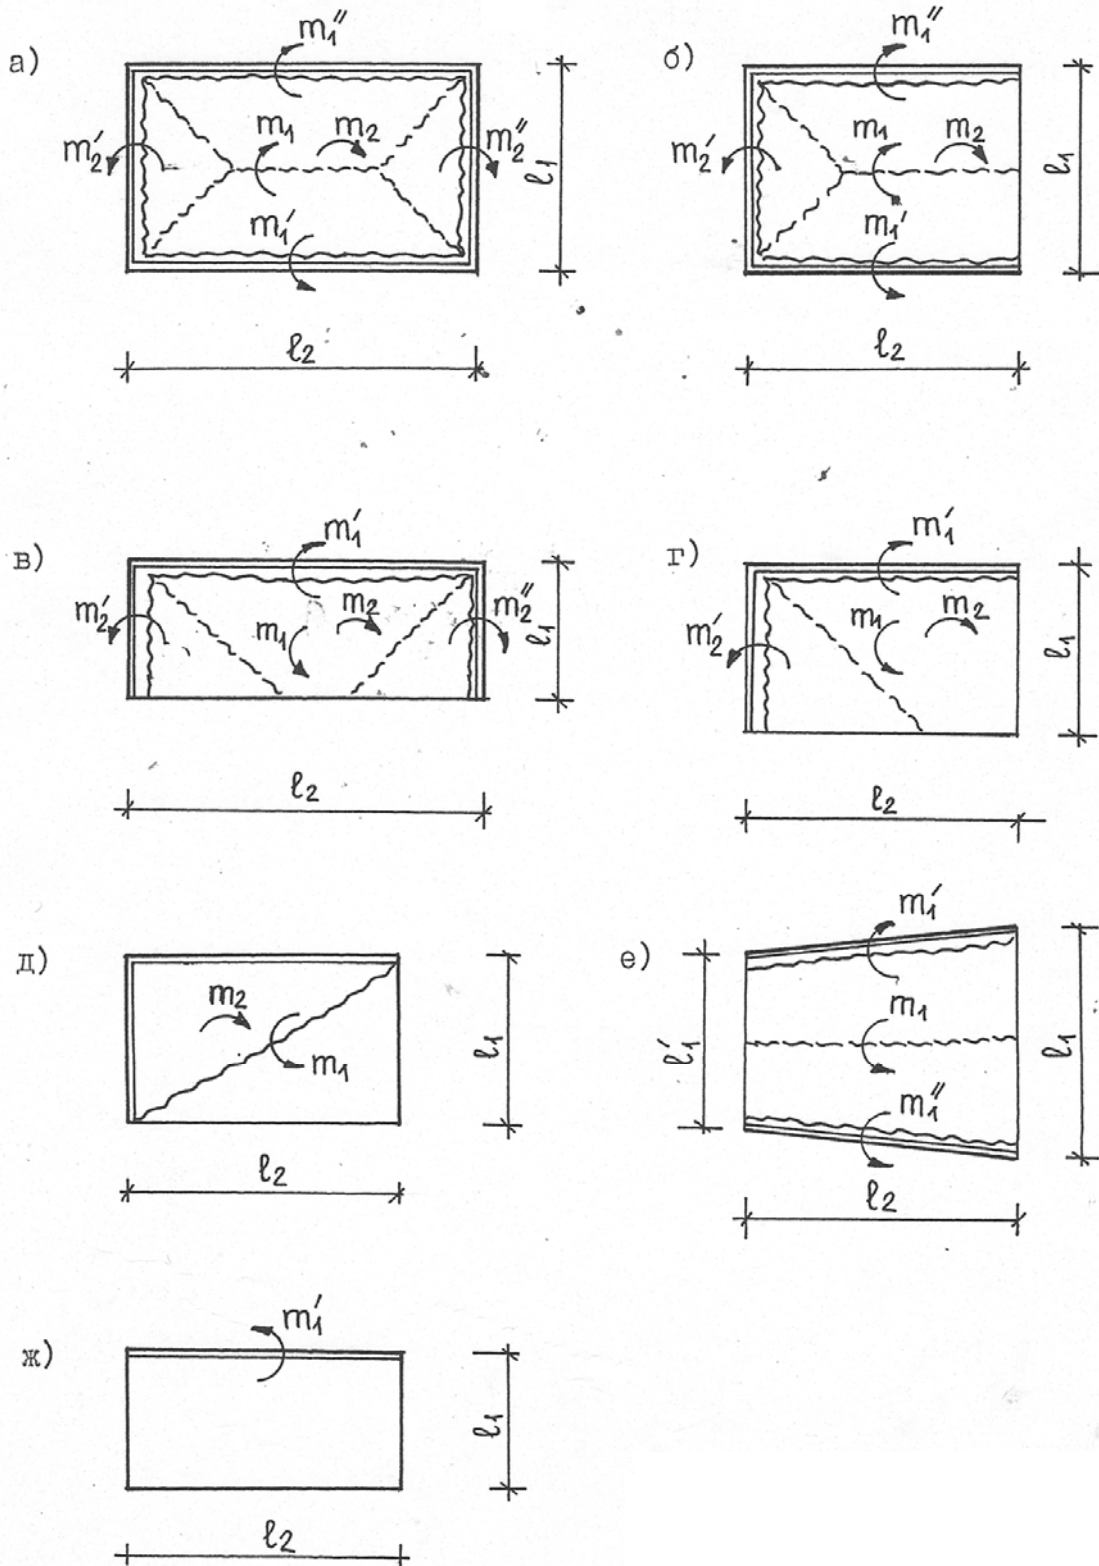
Разновидности механизмов разрушения участков сборных железобетонных плит перекрытий
